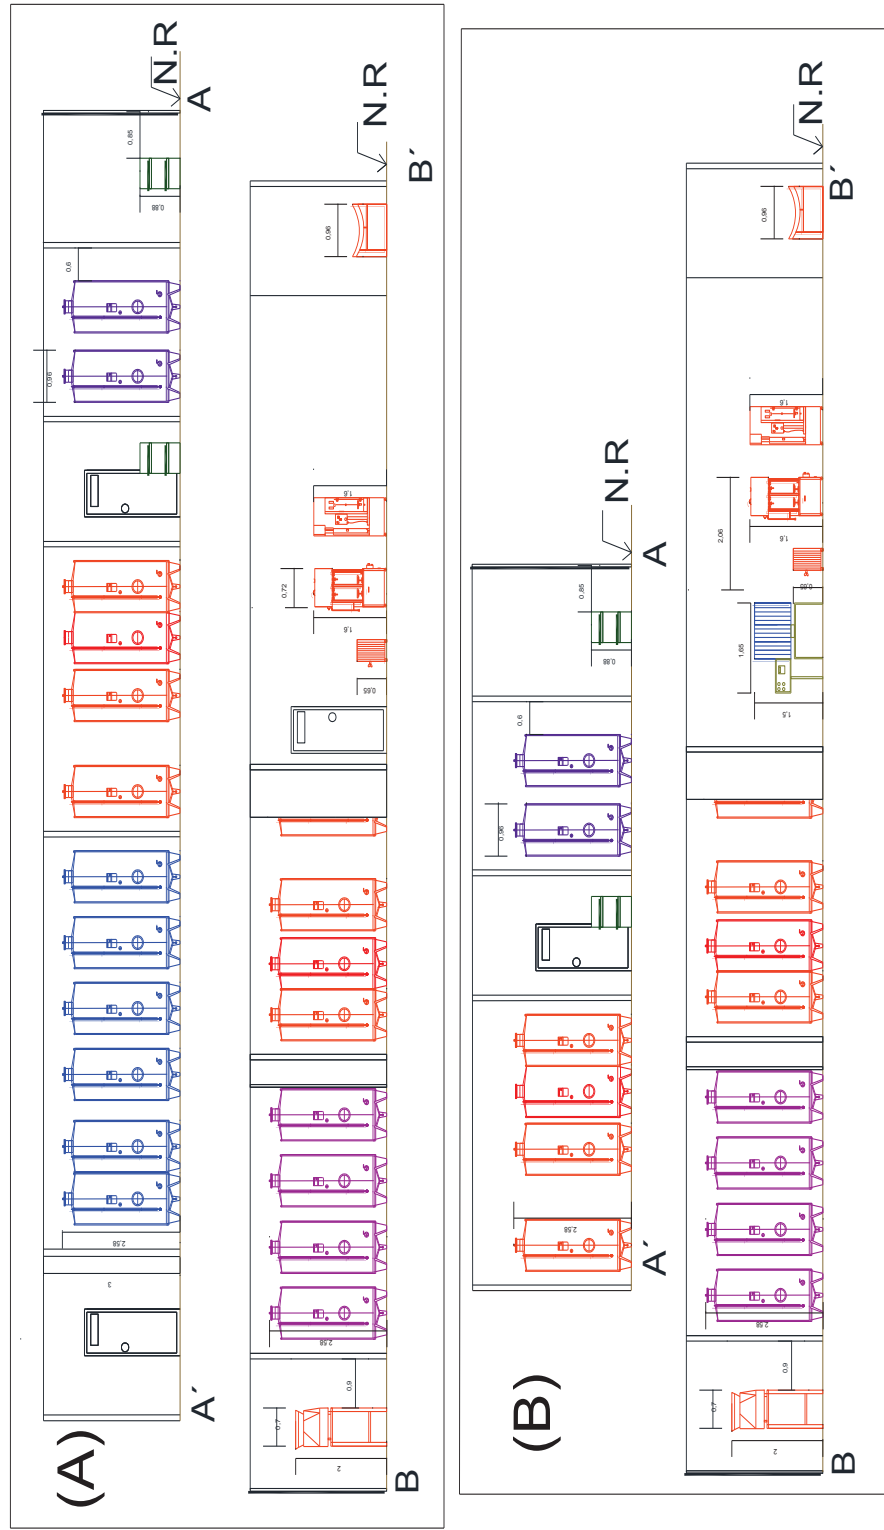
Elevaciones de los equipos de los cortes A'-A, B'-B' donde (A) representa la planta con estabilización con frío y (B) la planta con estabilización con electroválvulas
